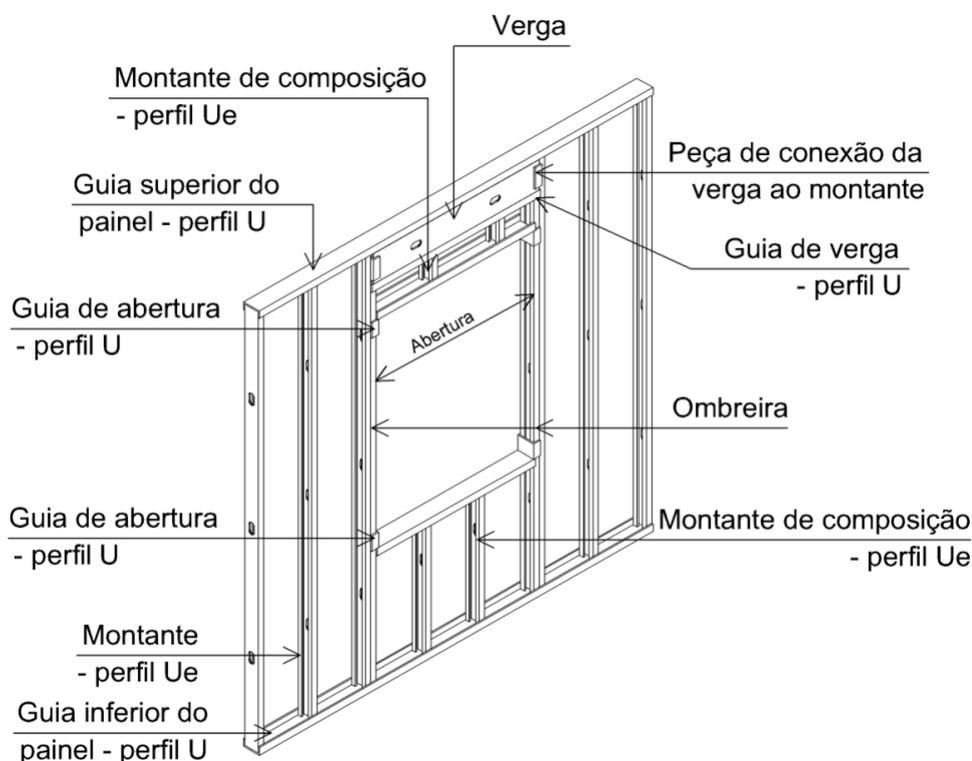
Desenho esquemático de painel estrutural com abertura
